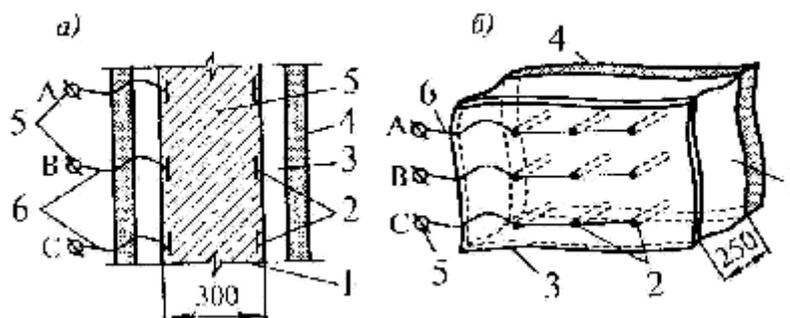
Схемы электропрогрева монолитных конструкций: *а* — стены; *б* — ленточную фундамента; 1 — забетонированная конструкция; 2 — электроды полосовые и стержневые; 3 — опалубка; 4 — теплоизоляция; 5 — контактные выводы; 6 — выводы электроразводки
